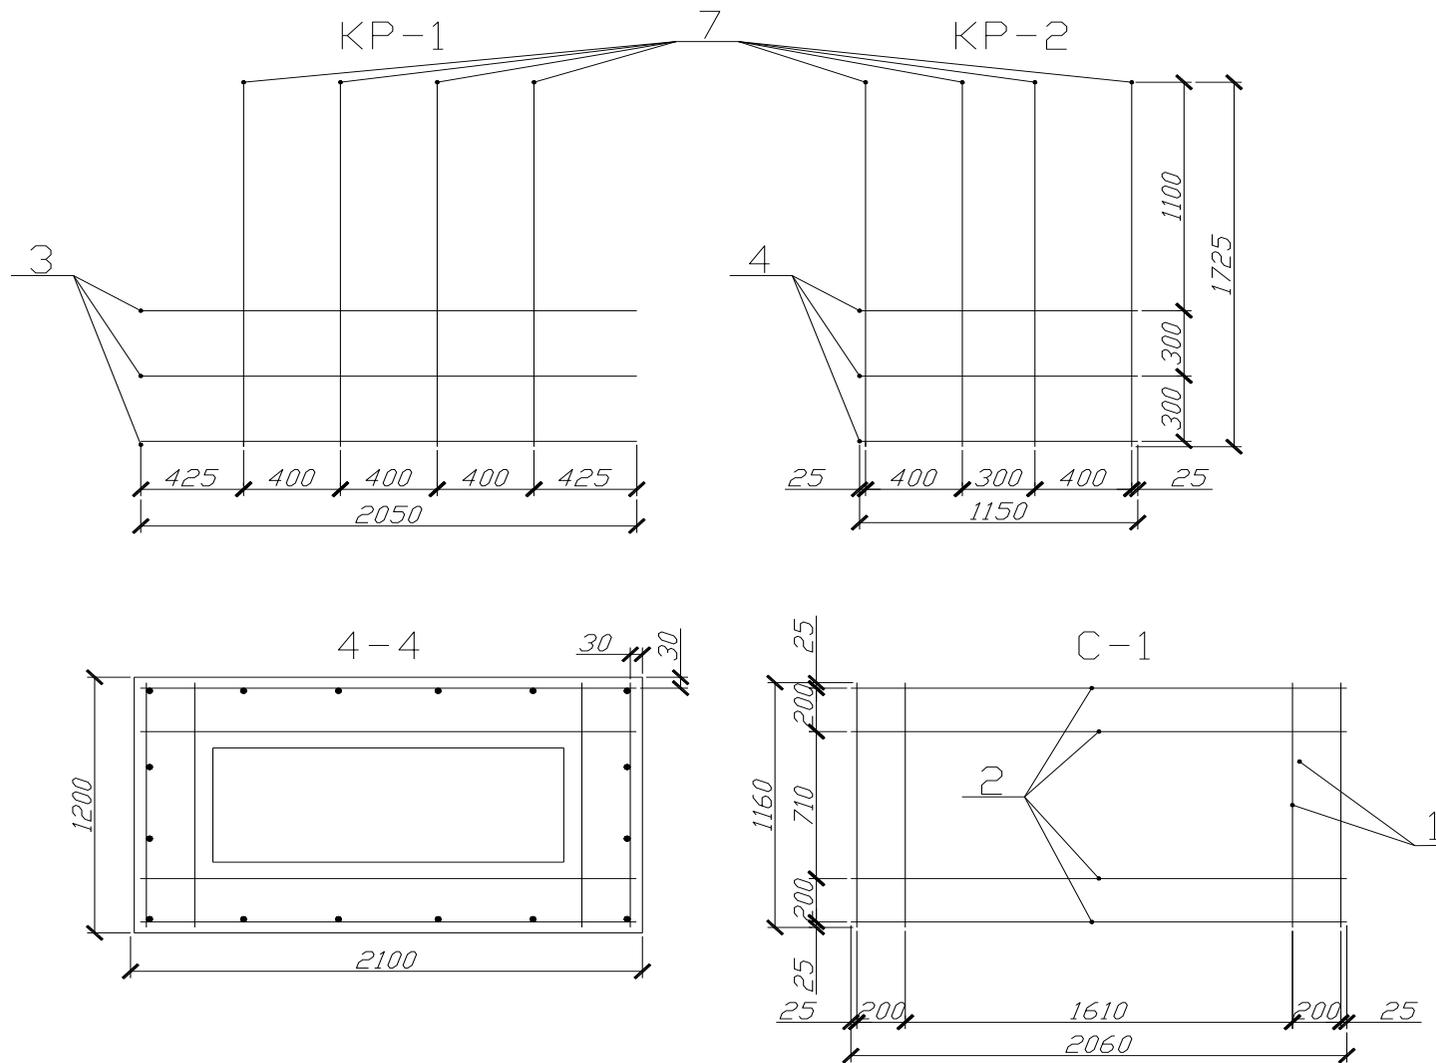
Арматурні каркаси КР- 1 та КР-2 і сітка С-1; розріз 4-4
